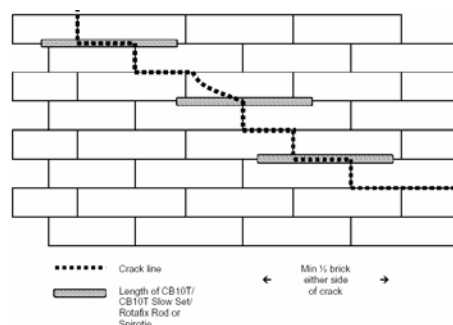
Esquema da fissuração e respectiva intervenção de reforço [8]
